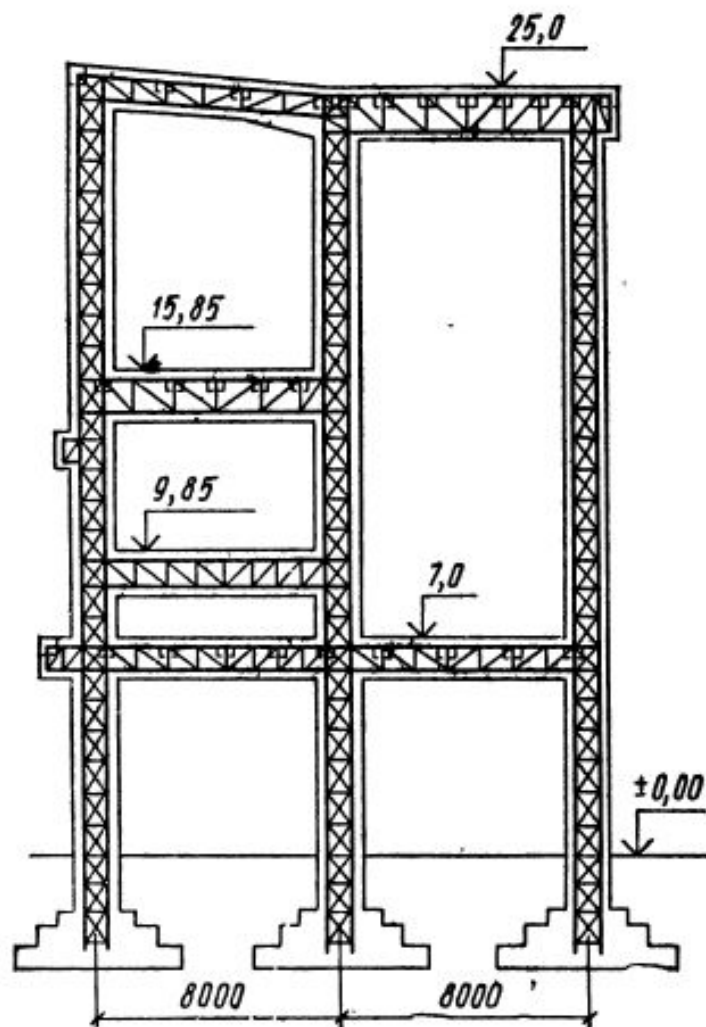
Ребристые сборно-монолитные перекрытия с остовом из железобетонных панелей
